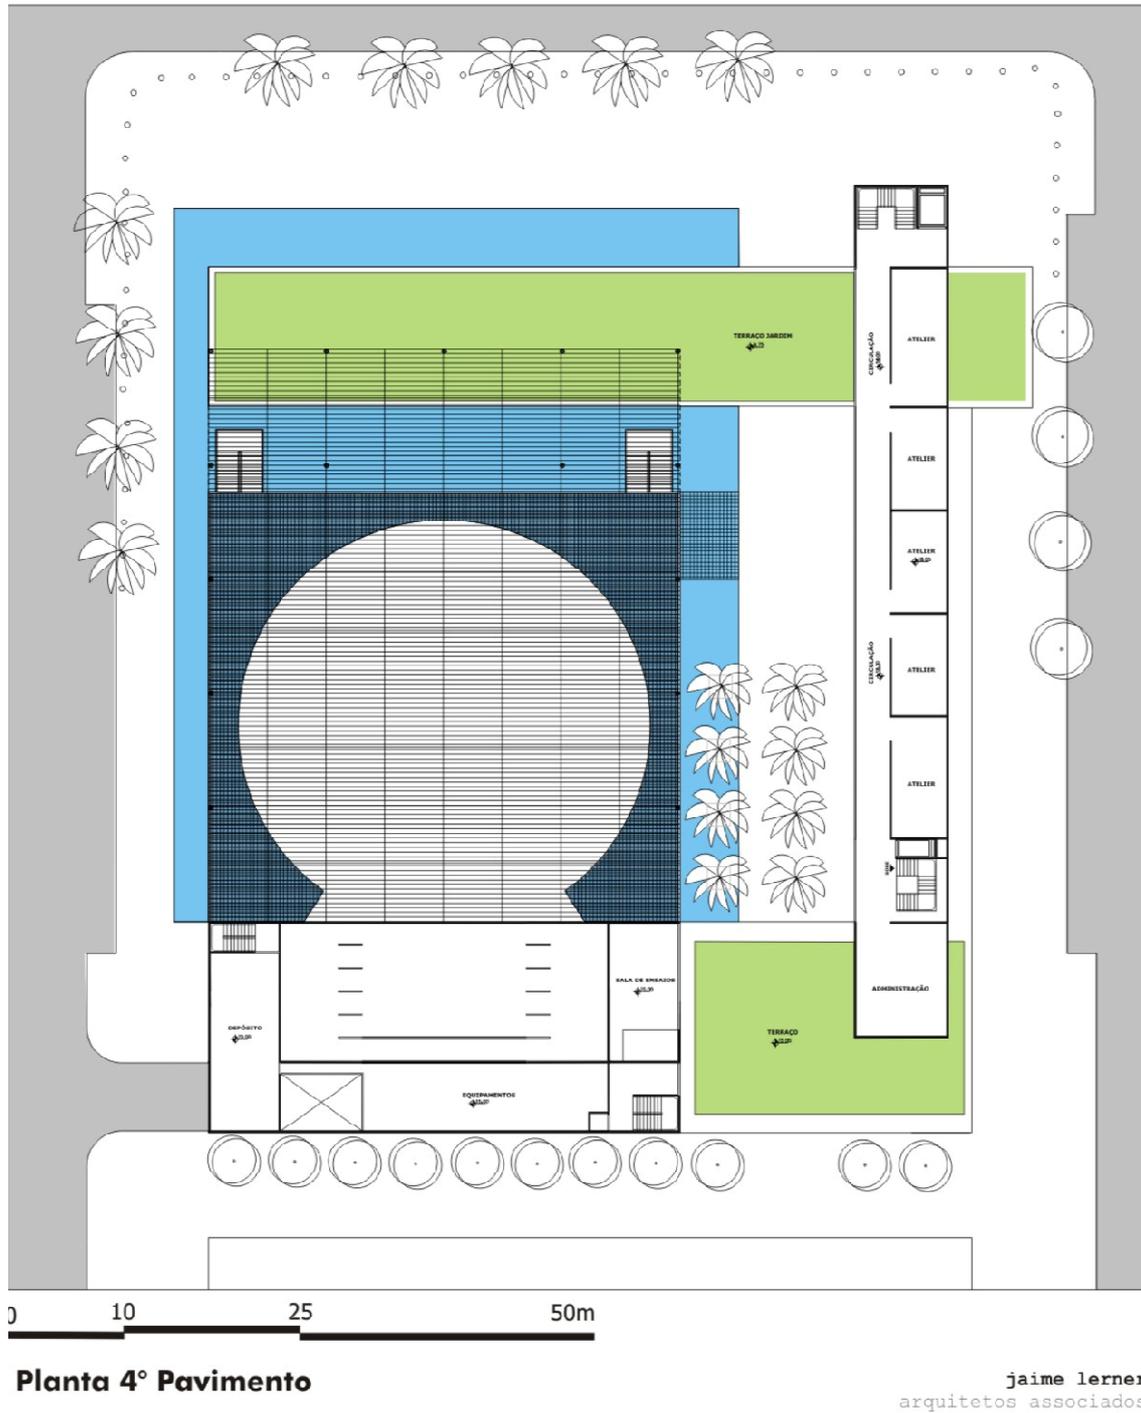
Planta do quarto andar da quadra do Centro Cultural.
